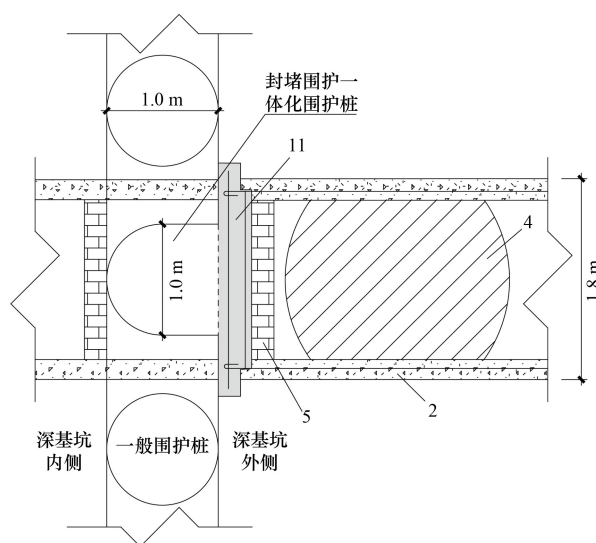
封堵围护一体化施工平面截面 (A-A 截面)
